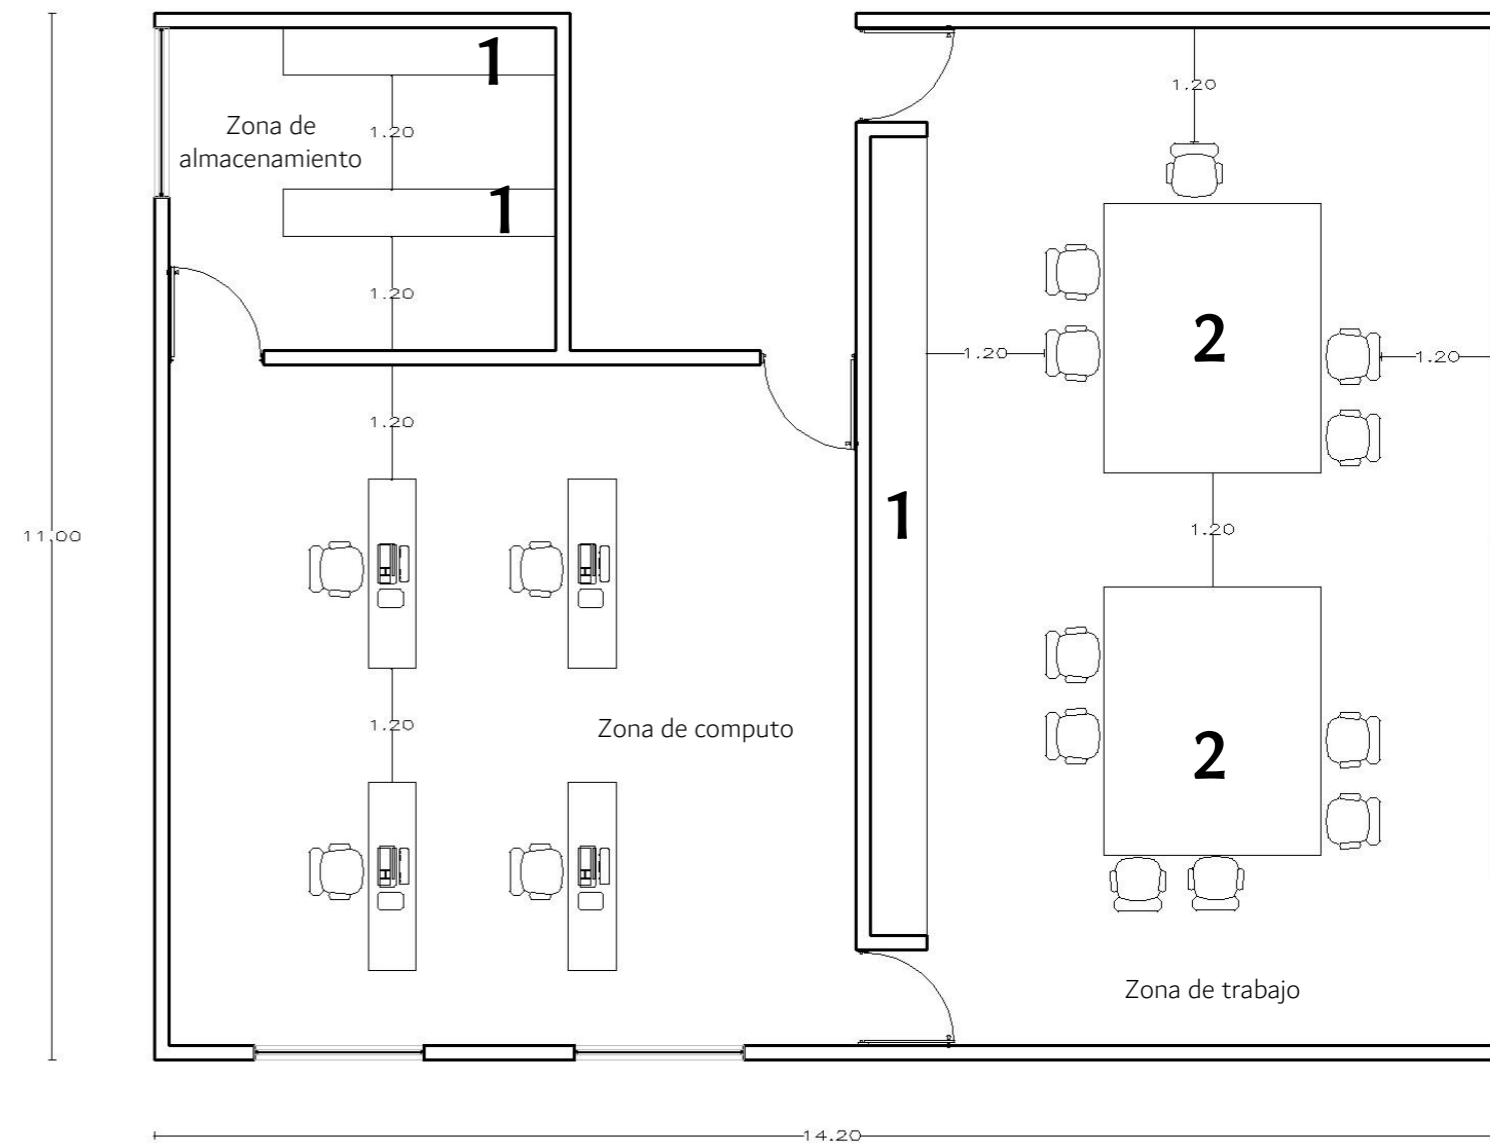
Ingeniería civil y Arquitectura. Elaboración propia
